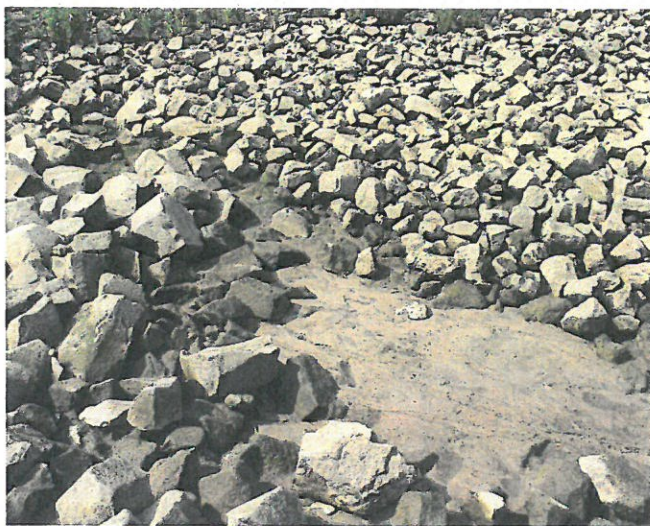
Deckwerksschäden;HDV02, Abschnitt 3; 2009; Foto: NLWKN
